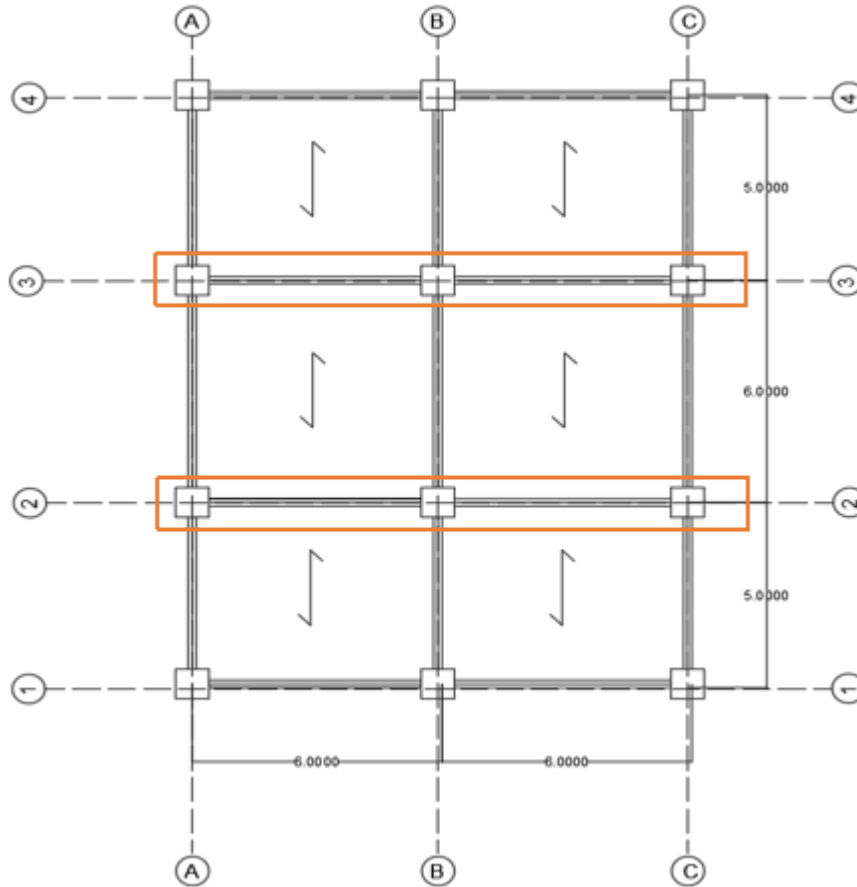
Vista en planta de la estructura especificando la ubicación de vigas cargadoras más críticas. Fuente: David González
